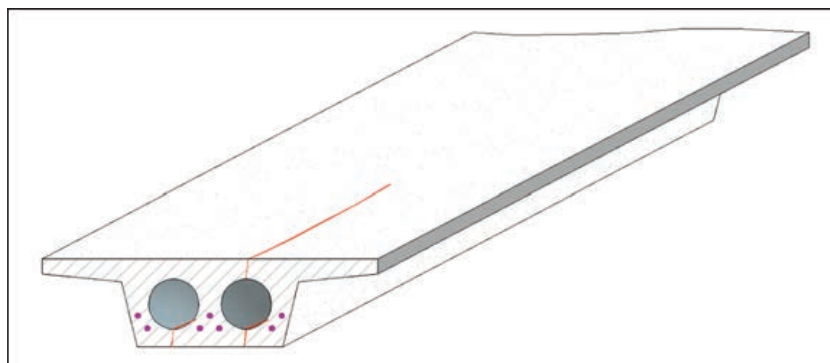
FISURAS EN LAS ZONAS DE MÍNIMO ESPESOR SOBRE O BAJO LOS ALVEOLOS, QUE TAMBIÉN TIENEN SU ORIGEN EN LA FASE DE EJECUCIÓN DEL HORMIGONADO.
